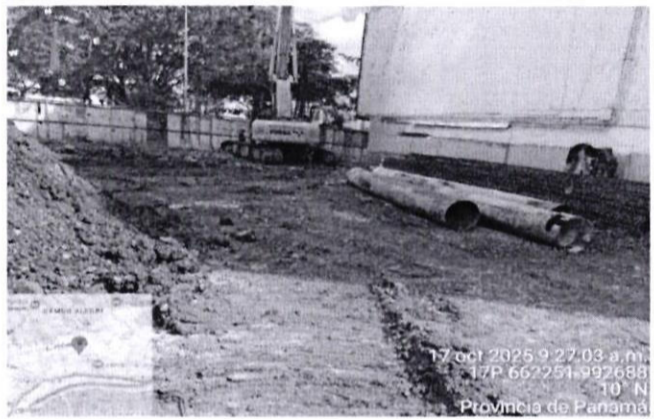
Vista de perforadora usado para la instalación de pilotes.
